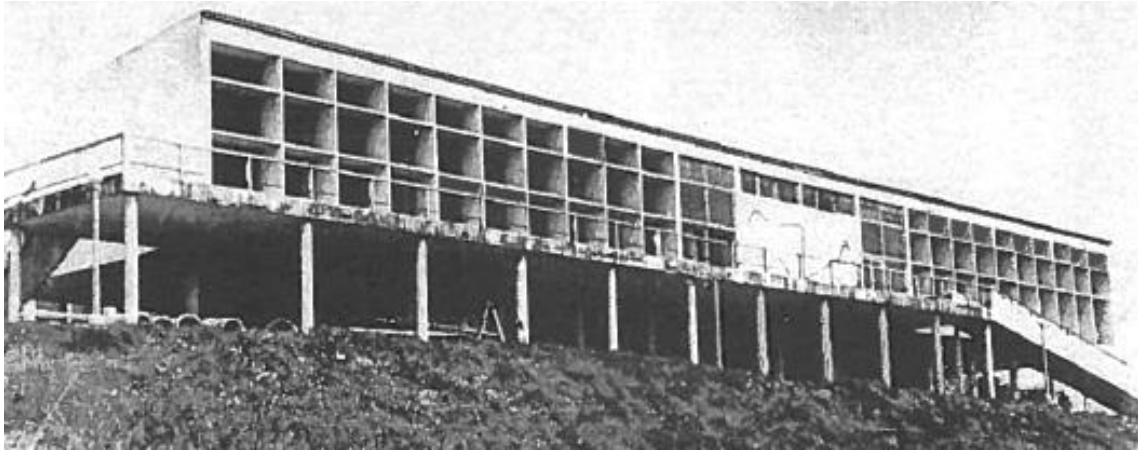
Construção Pavilhão do Refeitório (Fonte: DAD/Fiocruz)
